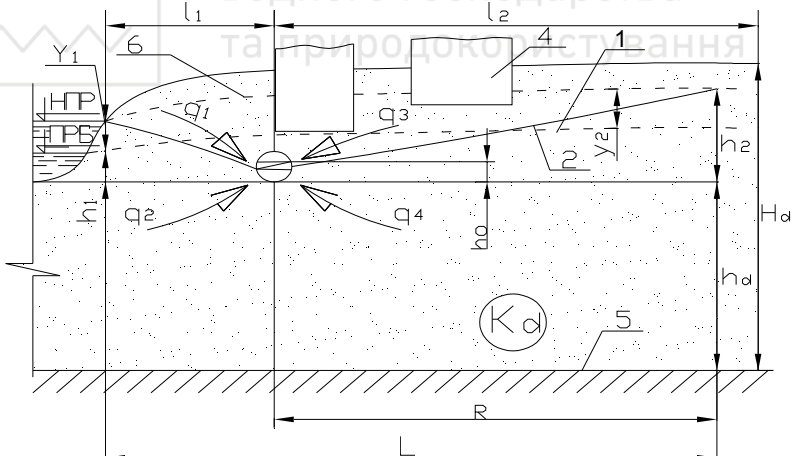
Розрахункова схема берегового горизонтального дренажу:
